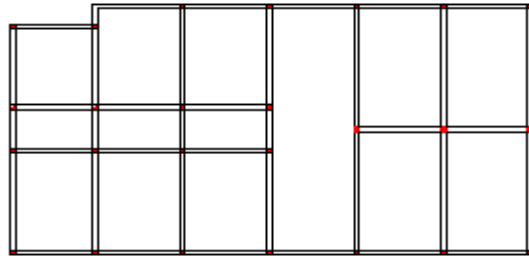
le système structural et un exemple de plan de structure des bâtiments existant.
